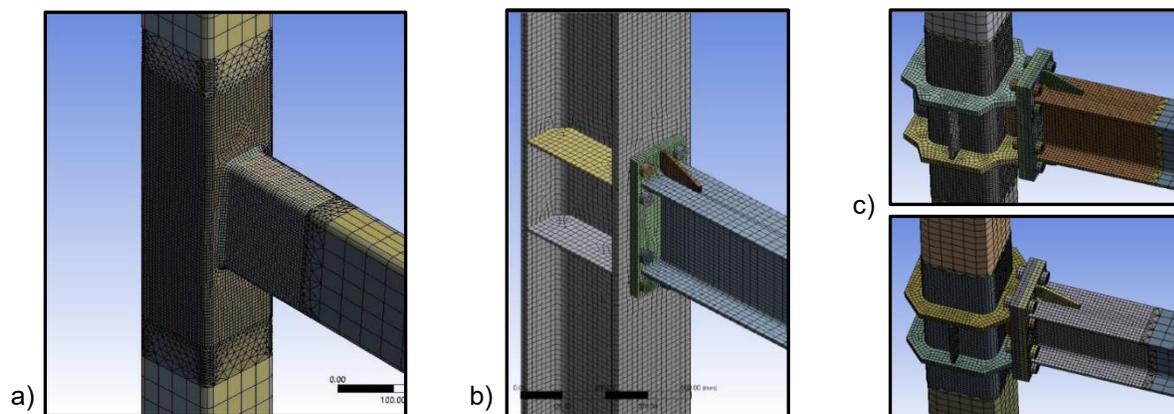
Modelos por elementos finitos de las conexiones analizadas. a) Soldadura Directa entre Perfiles Tubulares, b) Plancha Extrema y c) Tipo I y Tipo II CIDECT No.9.
